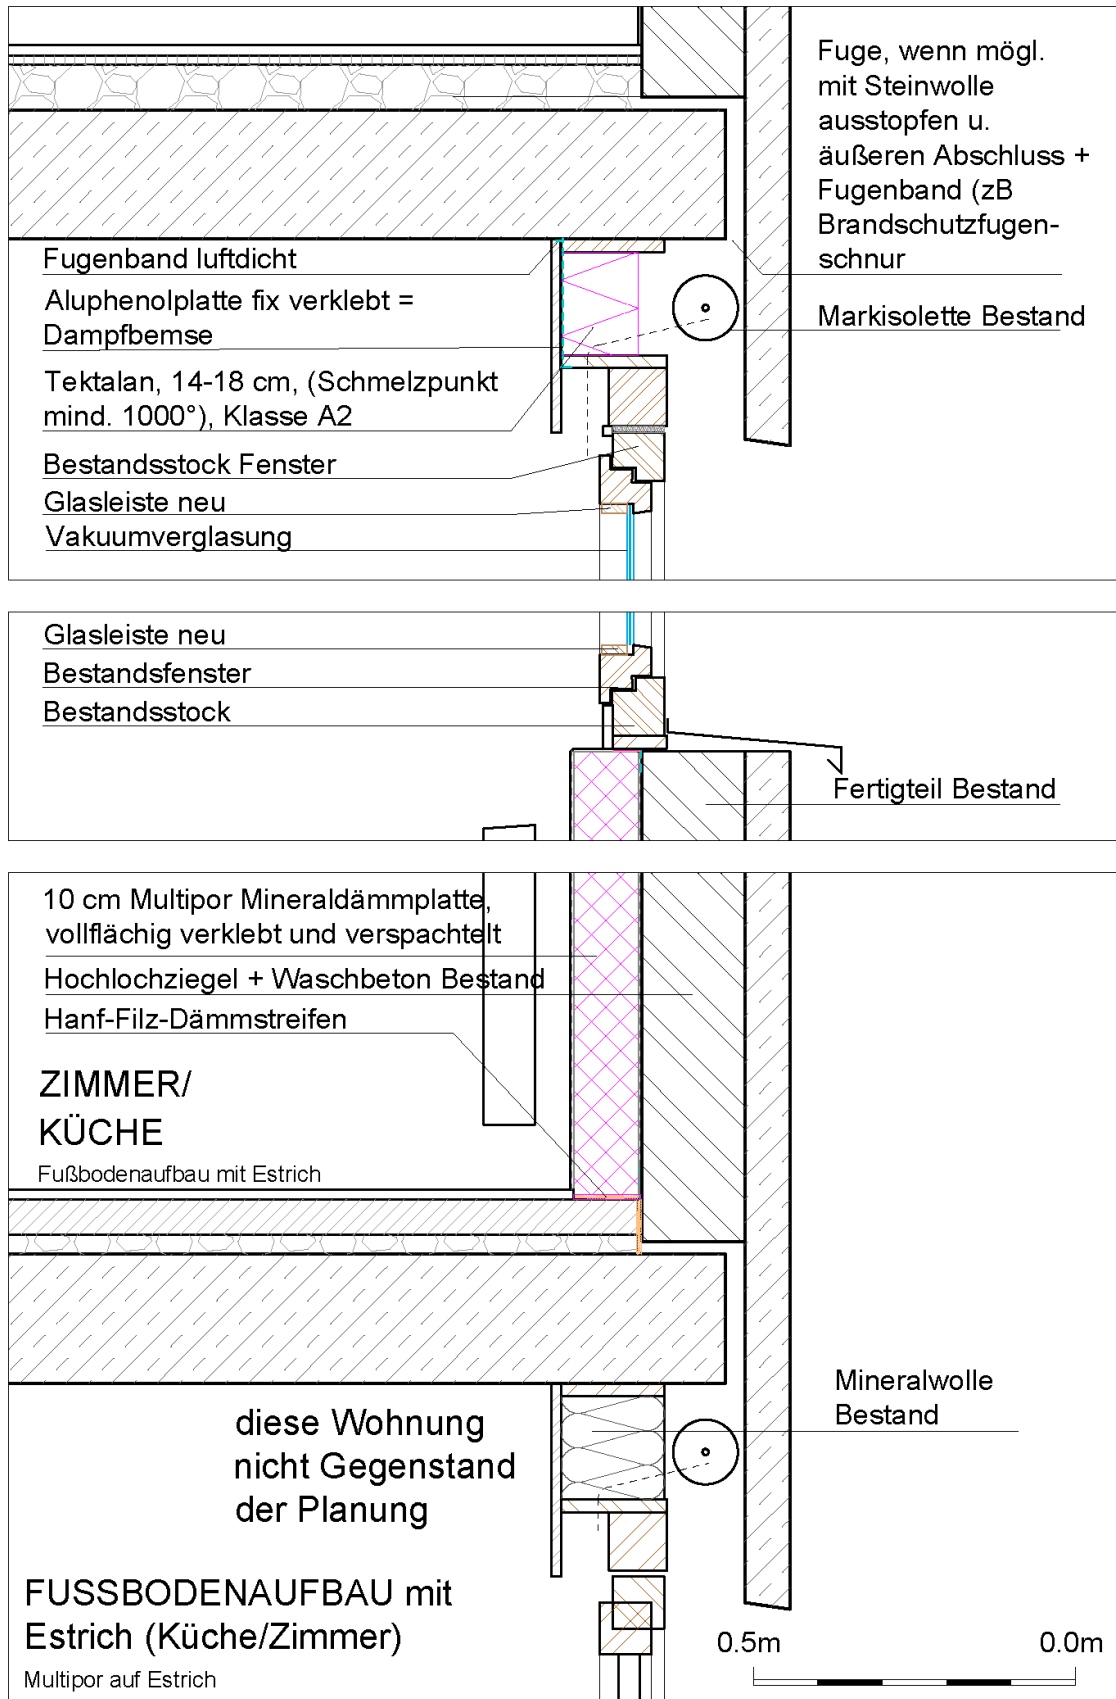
Grundriss - Brandschutzertüchtigung zur Nachbarwohnung, RfM Architektur
